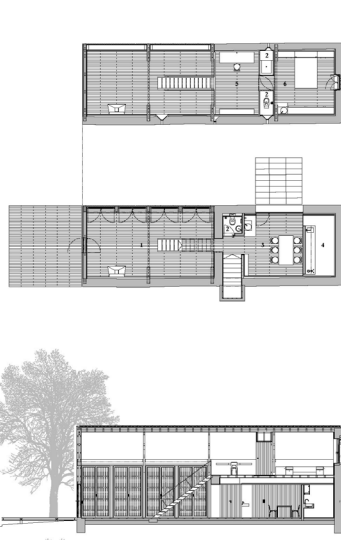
| Plantas e secção do projecto para reconversão de um palheiro, do Arqº João Mendes Ribeiro
